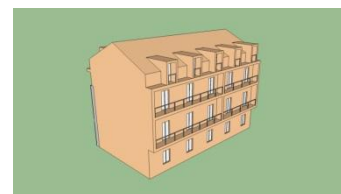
SOLUÇÃO B Modelo 3D: Edifício construído com painéis de CLT mantendo parede existente de alvenaria
